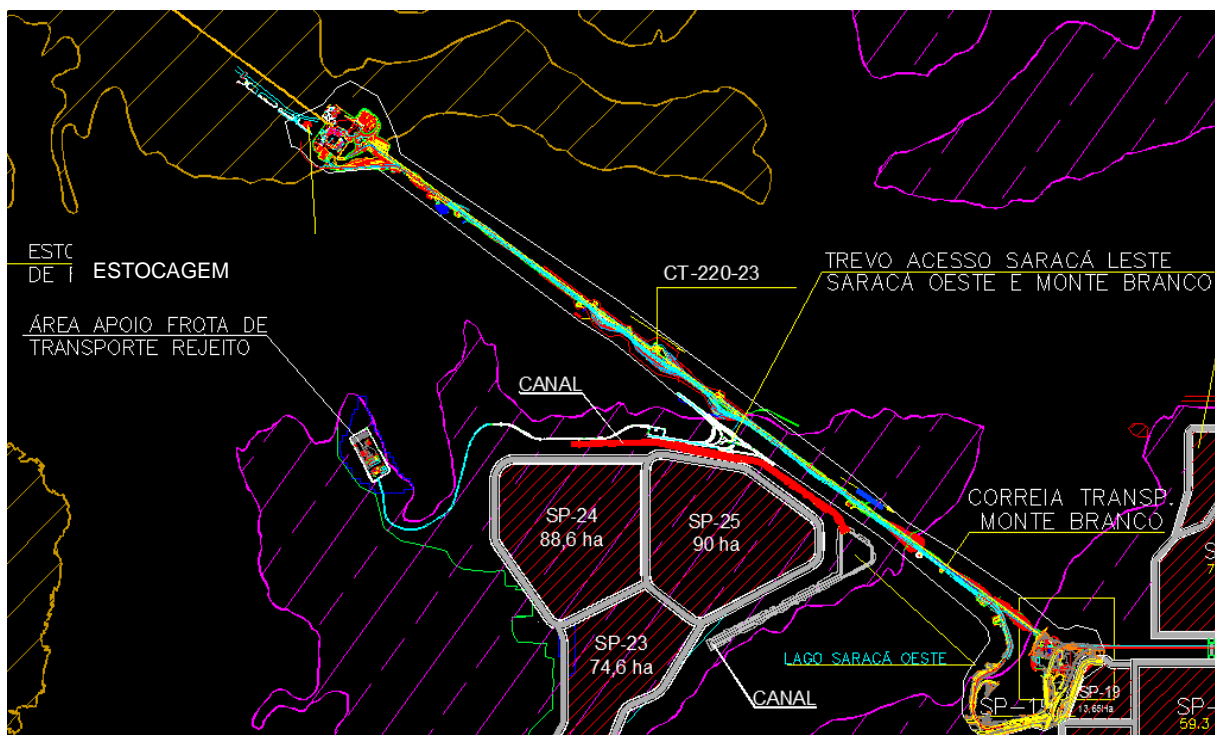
Localização da Área de Apoio à Frota de Escavação e Transporte de Rejeito
